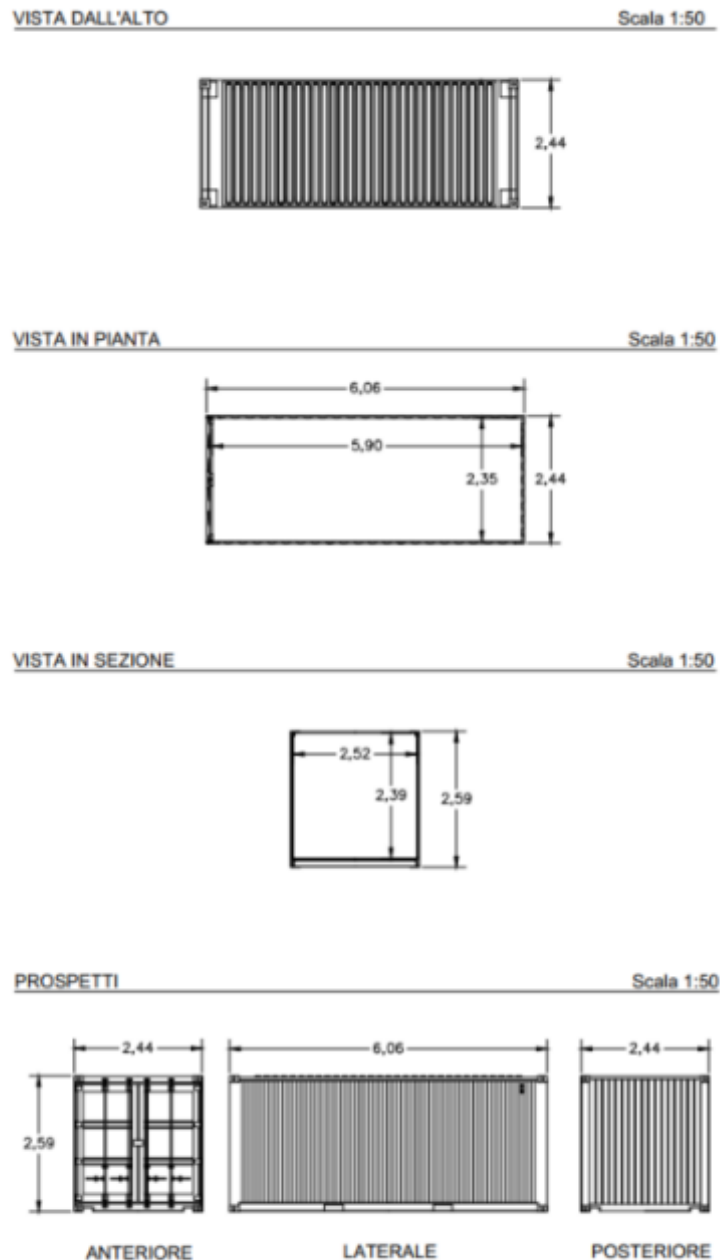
Pianta, prospetti e sezioni container di controllo
